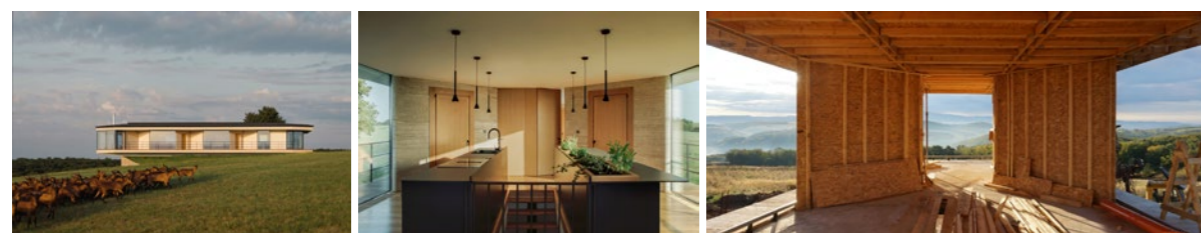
Hemp House a) Fachada; b) Interior; c) Processo de construção. Fonte: ArchDaily.
